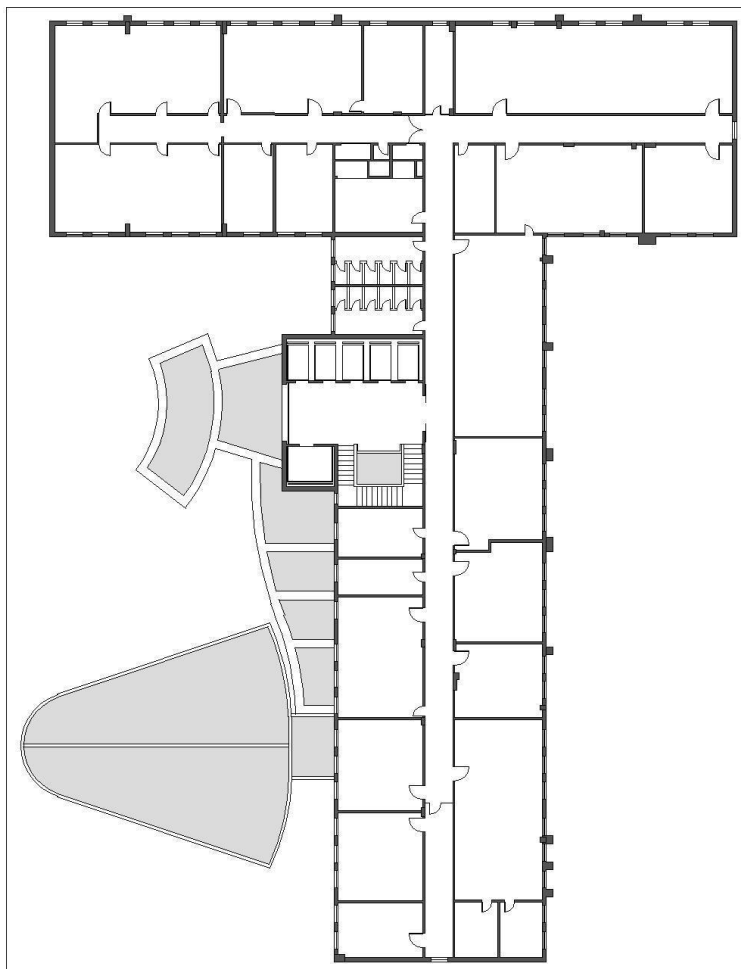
Planta do imóvel - Pavimento tipo - Ed. Arthur da Costa Guimarães
